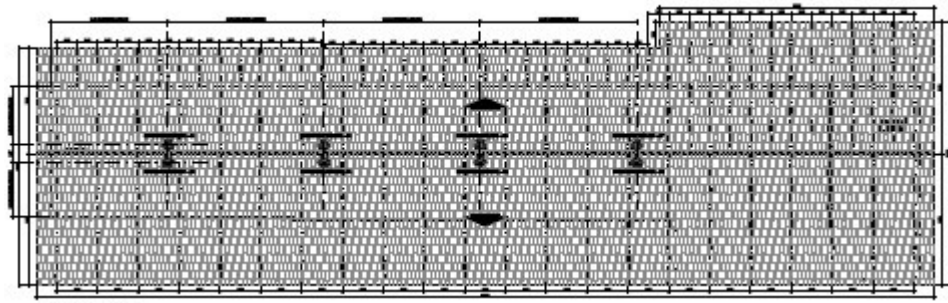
1.070,81 metros quadrados do telhado concluído, 100 %.
